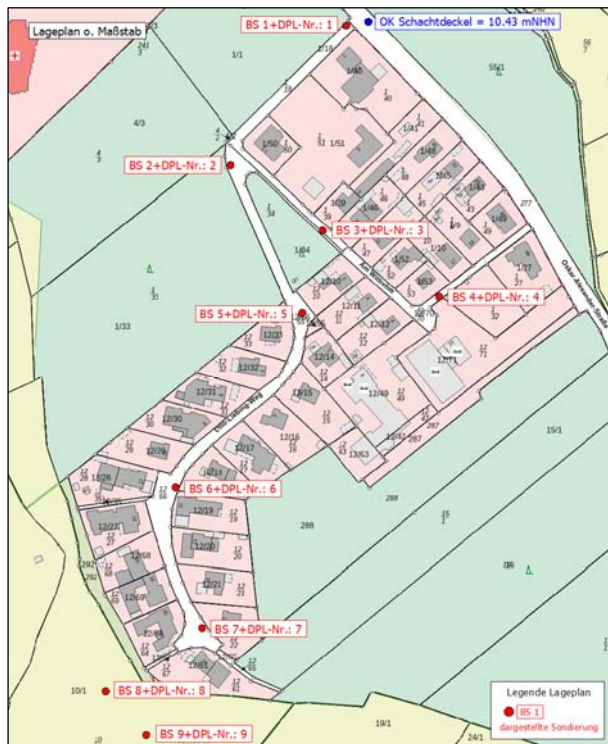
Lageplan Anl. 1.1 (o. M.)
